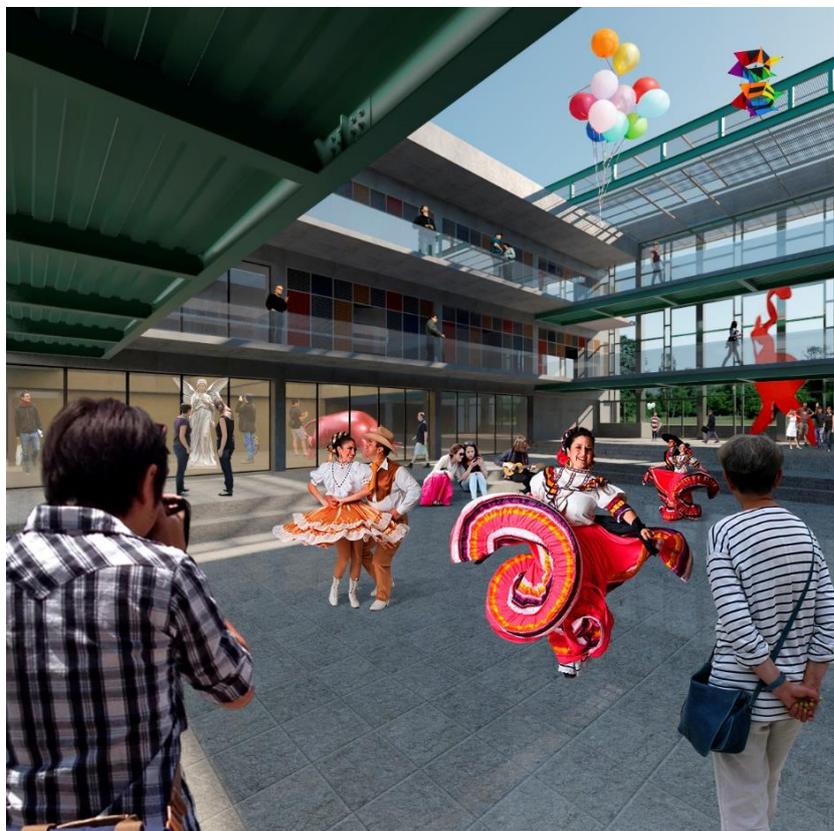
Vista de la fachada principal desde la plaza cívica.
